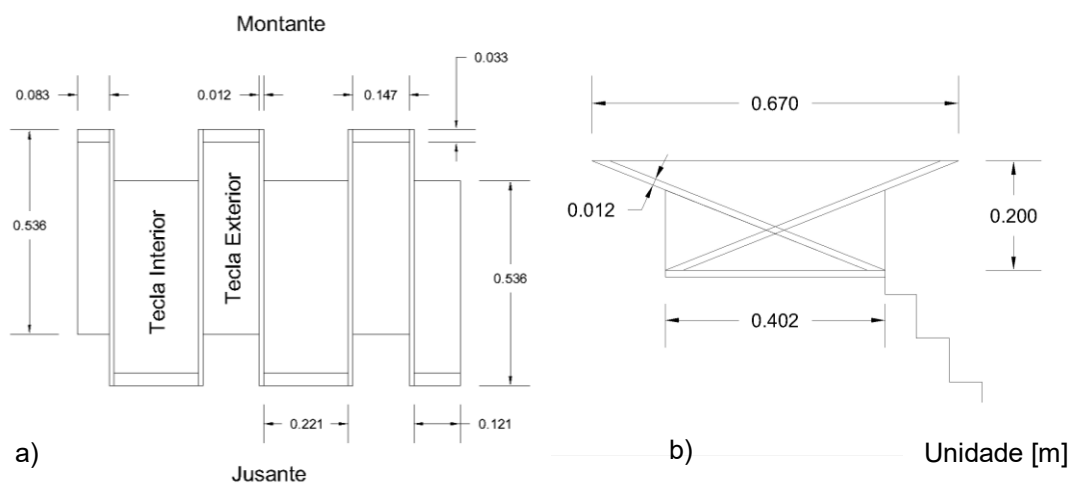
Soleira descarregadora do tipo PKW do presente estudo: a) planta; b) alçado.
